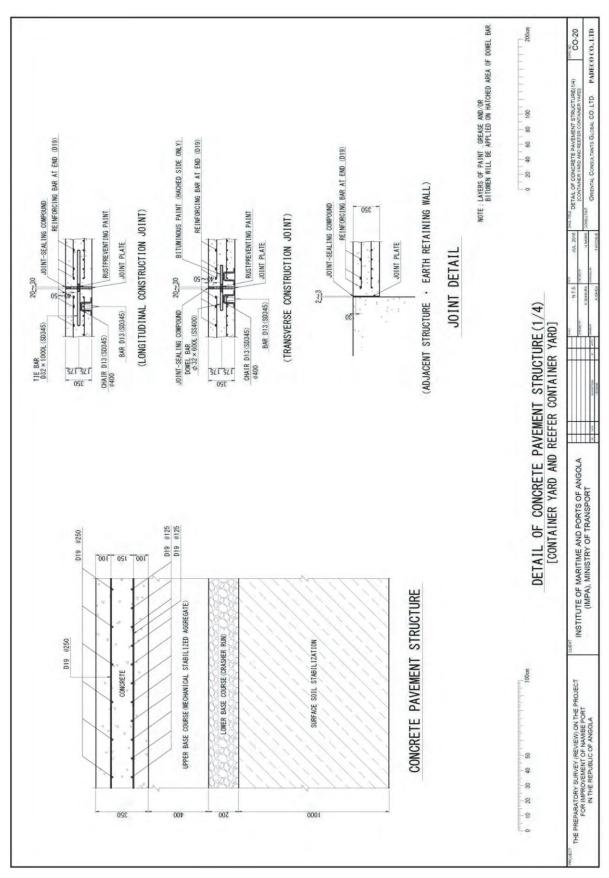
Desenho Estrutural do Pavimento do Cais e do Parque
